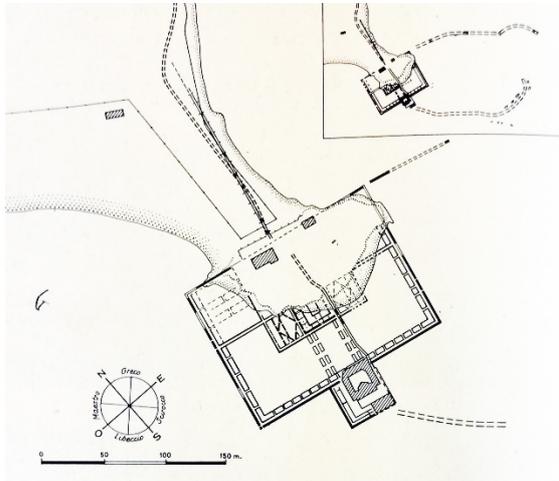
Planta de la *Peschiera di Torre Astura*, Nettuno, Italia, de planta rectangular.
